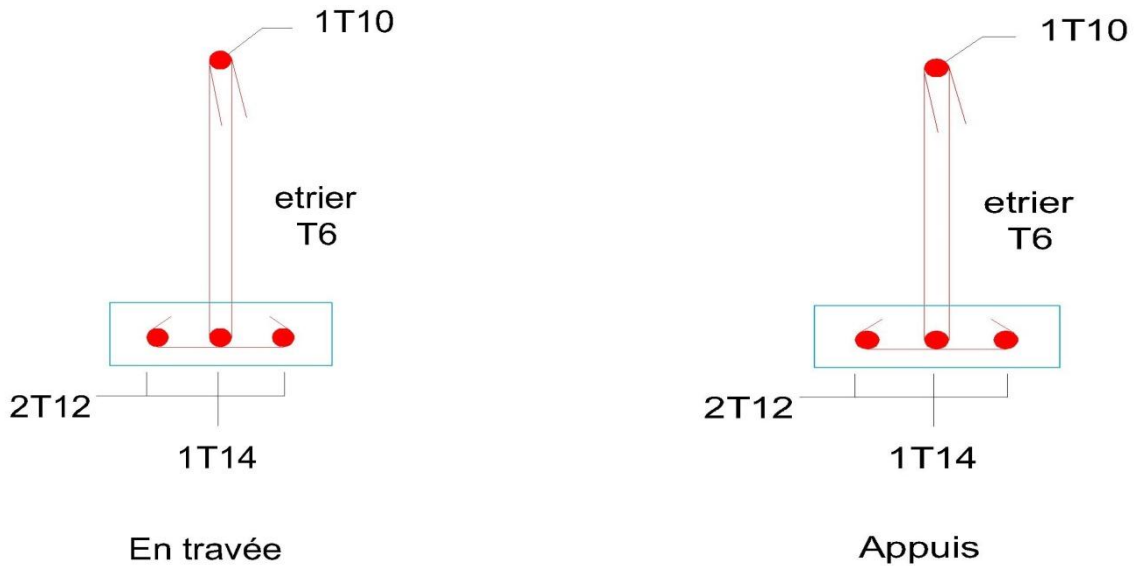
Schéma de ferrailage des poutrelles type 3 de l'étage bureau
